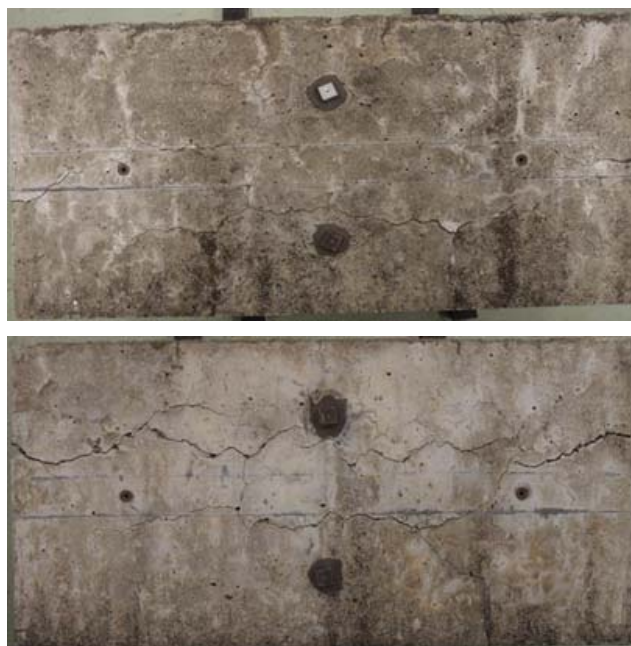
供試体のひび割れ状況(上: A, 下: B(S))
